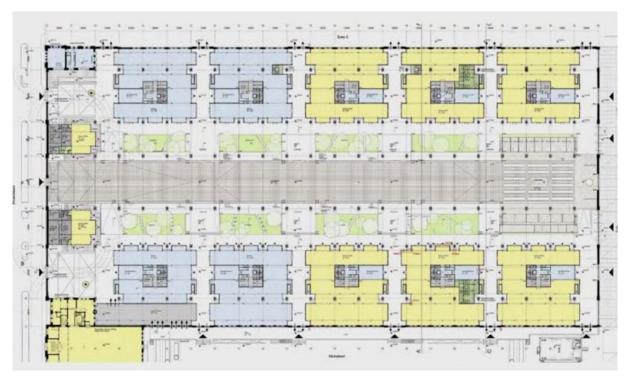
10 Blöcke und 2 Kopfbauten im Grundriss (Quelle: Extensa)
